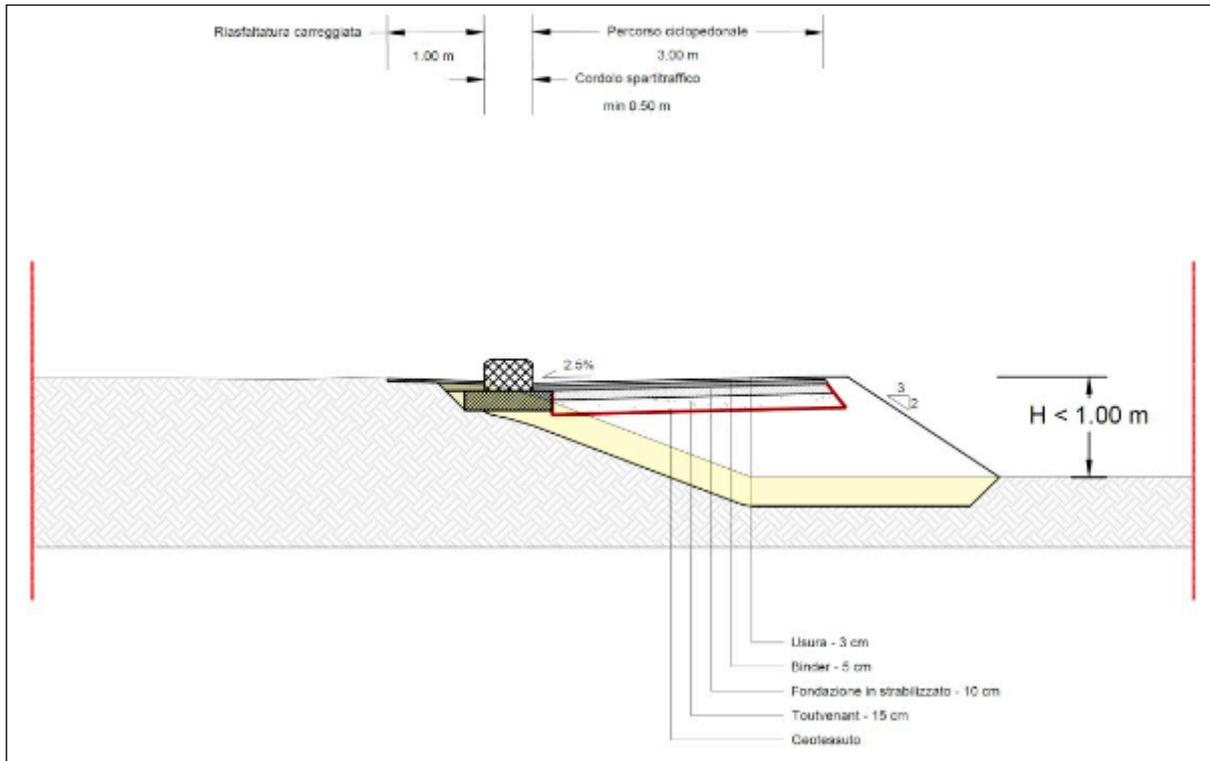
Sezione E9 – Nuova ciclovie in via Borghetto
